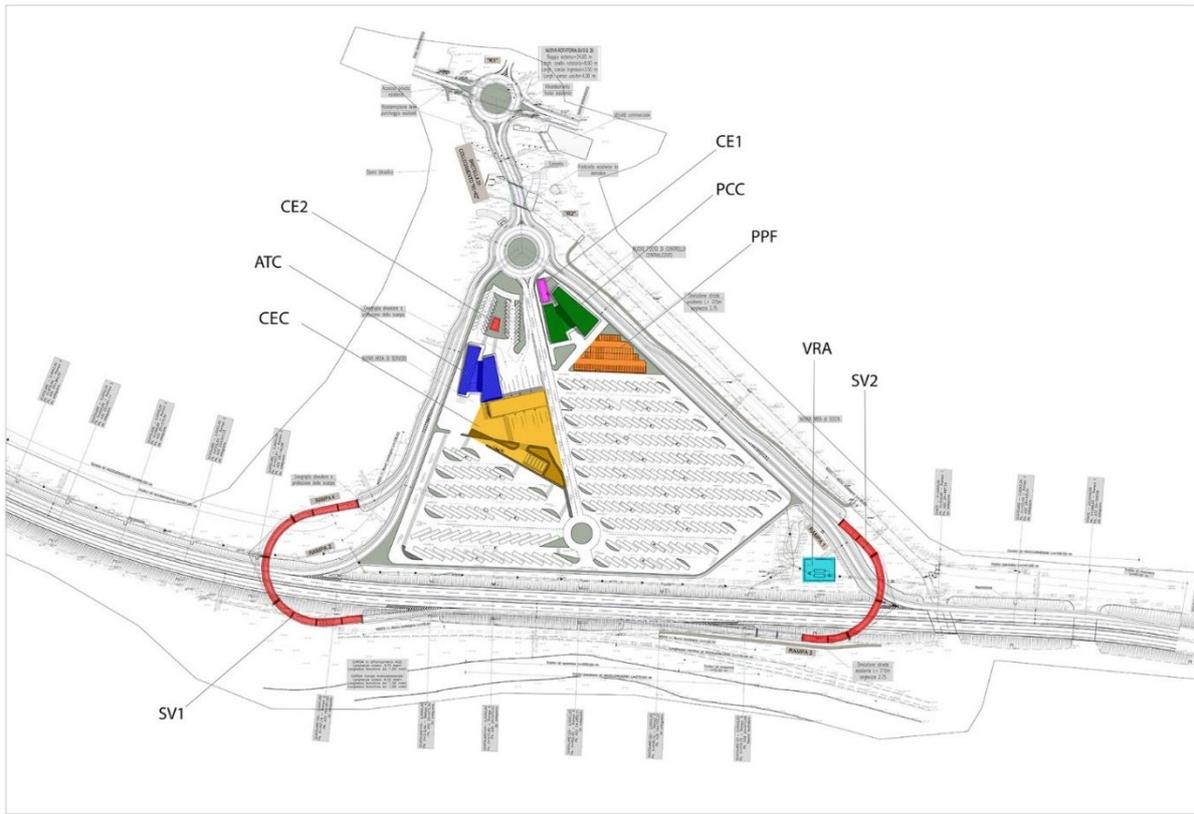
Posizione nel progetto dei blocchi funzionali “Building”
